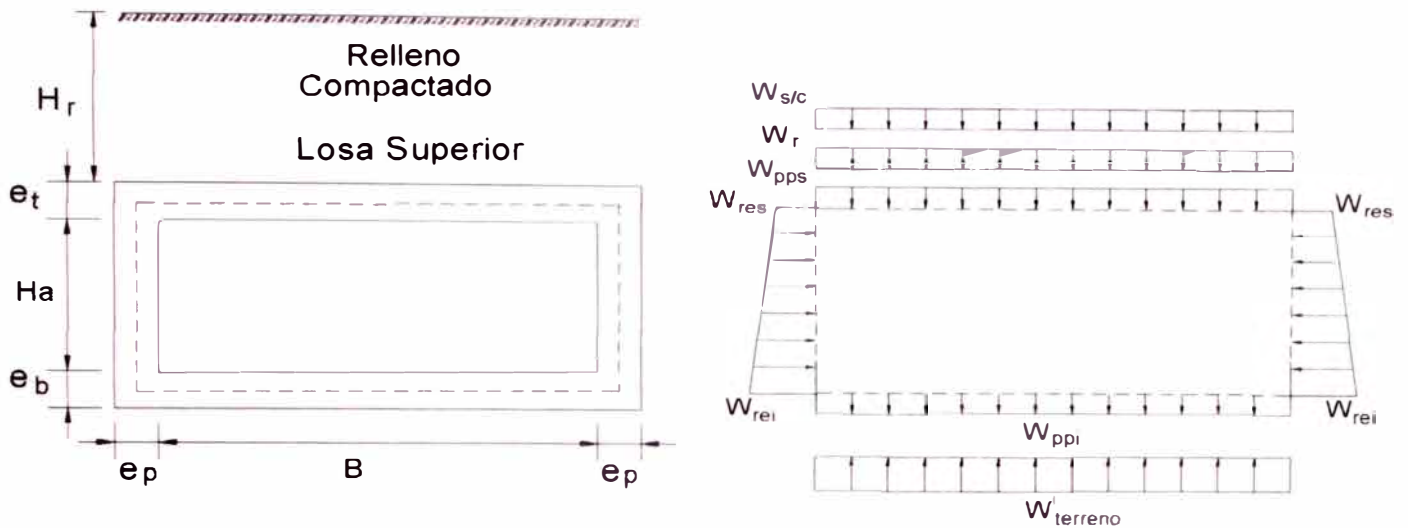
Cargas en Losa y Paredes de Alcantarilla Vacía
